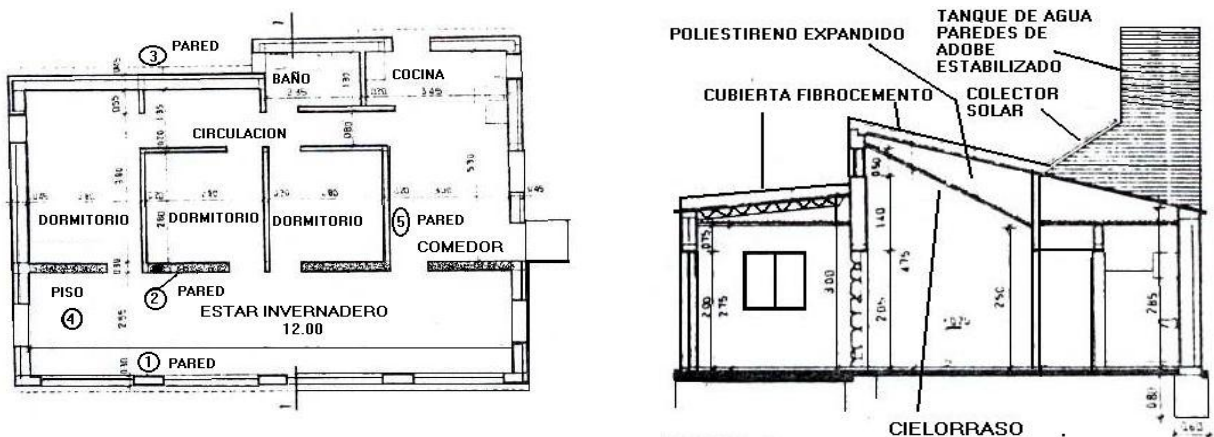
Planta y corte de las viviendas (Nadra et al)
